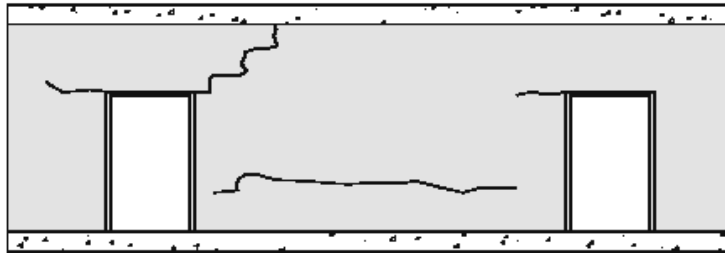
Fissuras em parede com aberturas, causadas pela deformação dos componentes estruturais (estt, 2016)
